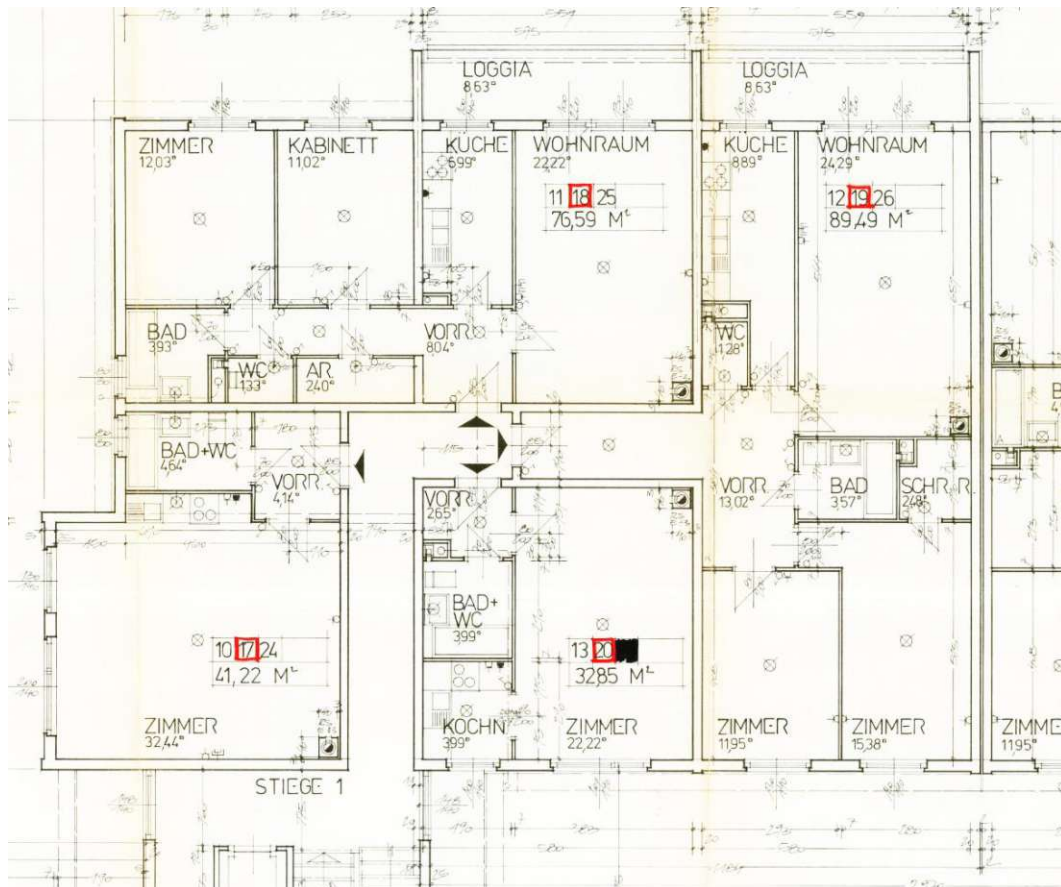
Auszug eines Regelgeschoßgrundrisses eines Mehrfamilienwohnbaus Baujahr 1982 (Auszug Bestandsplan Objekt 1110 Wien Kaiser-Ebersdorferstraße 212-216)
